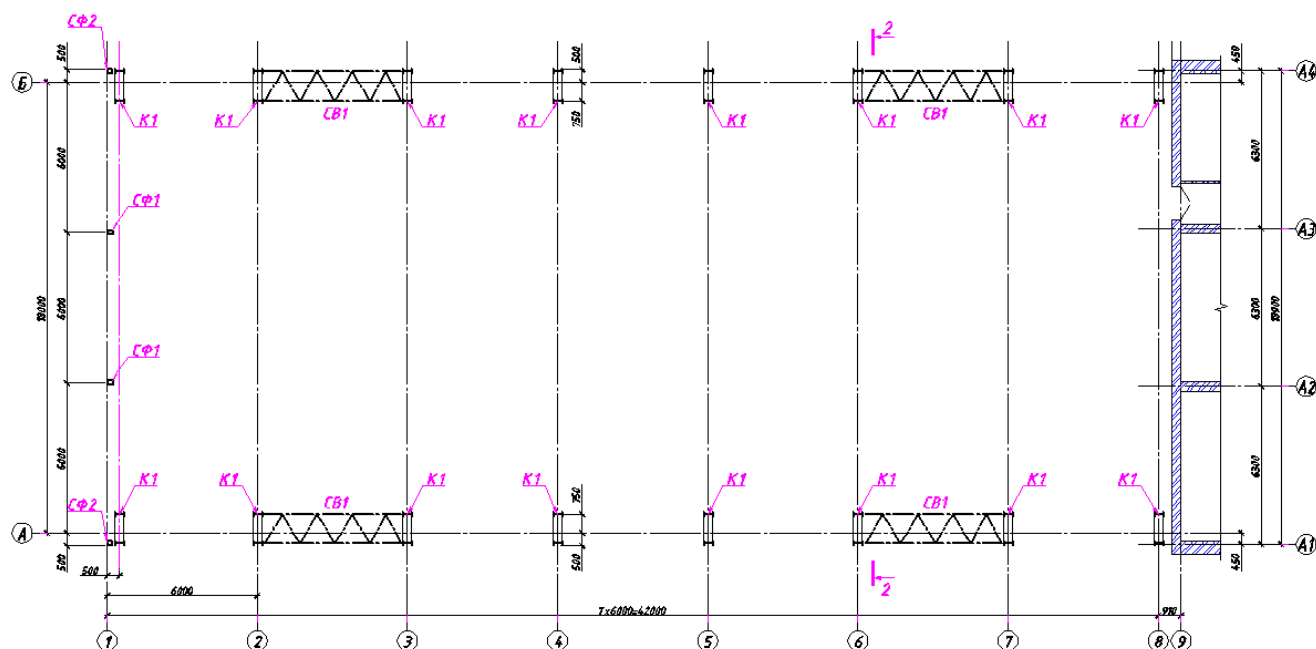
Схема расположения колонн и стоек фахверка на отм. 0,000
